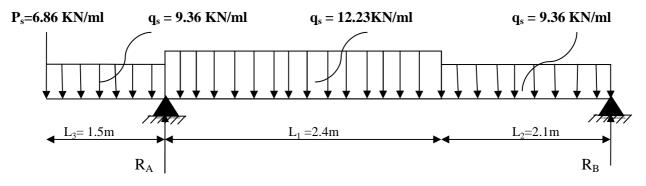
Schéma statique d'escalier à l'ELS.
